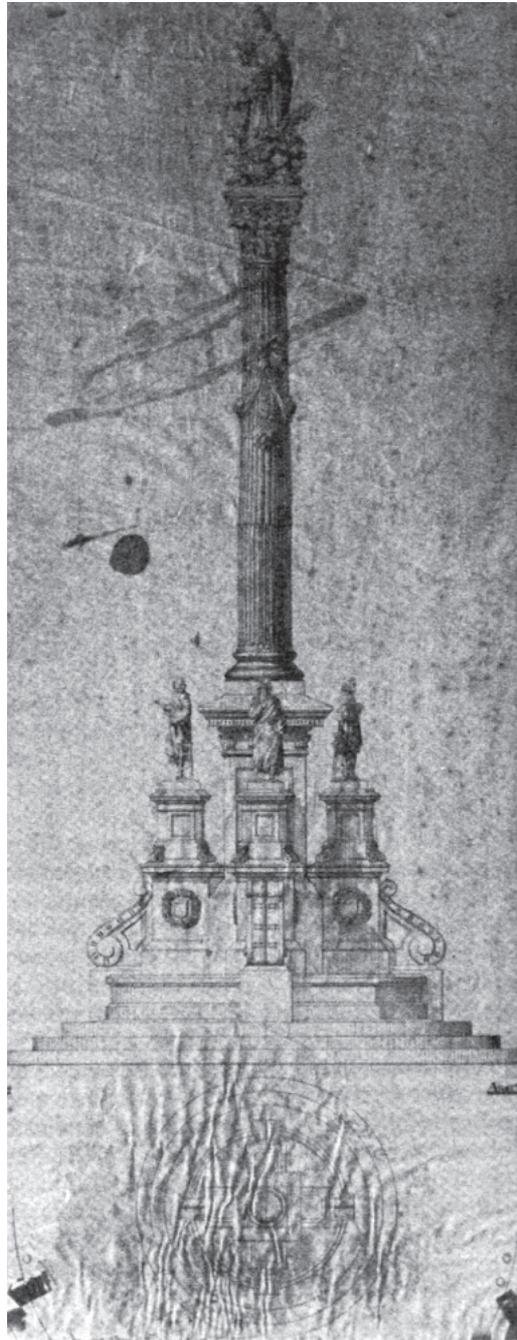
Archivo Espiau, Mto. 1. (6). Original, planta y alzado. Tinta negra sobre papel tela.
